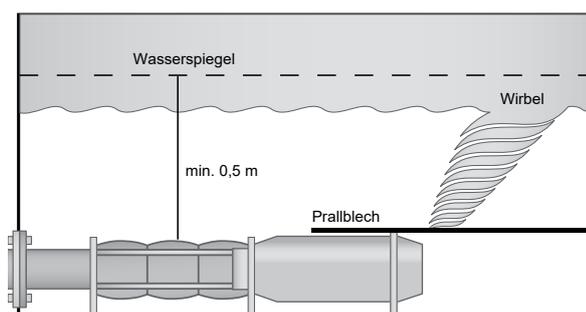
Horizontal installierte Unterwasserpumpe mit montiertem Prallblech (Querschnitt)
